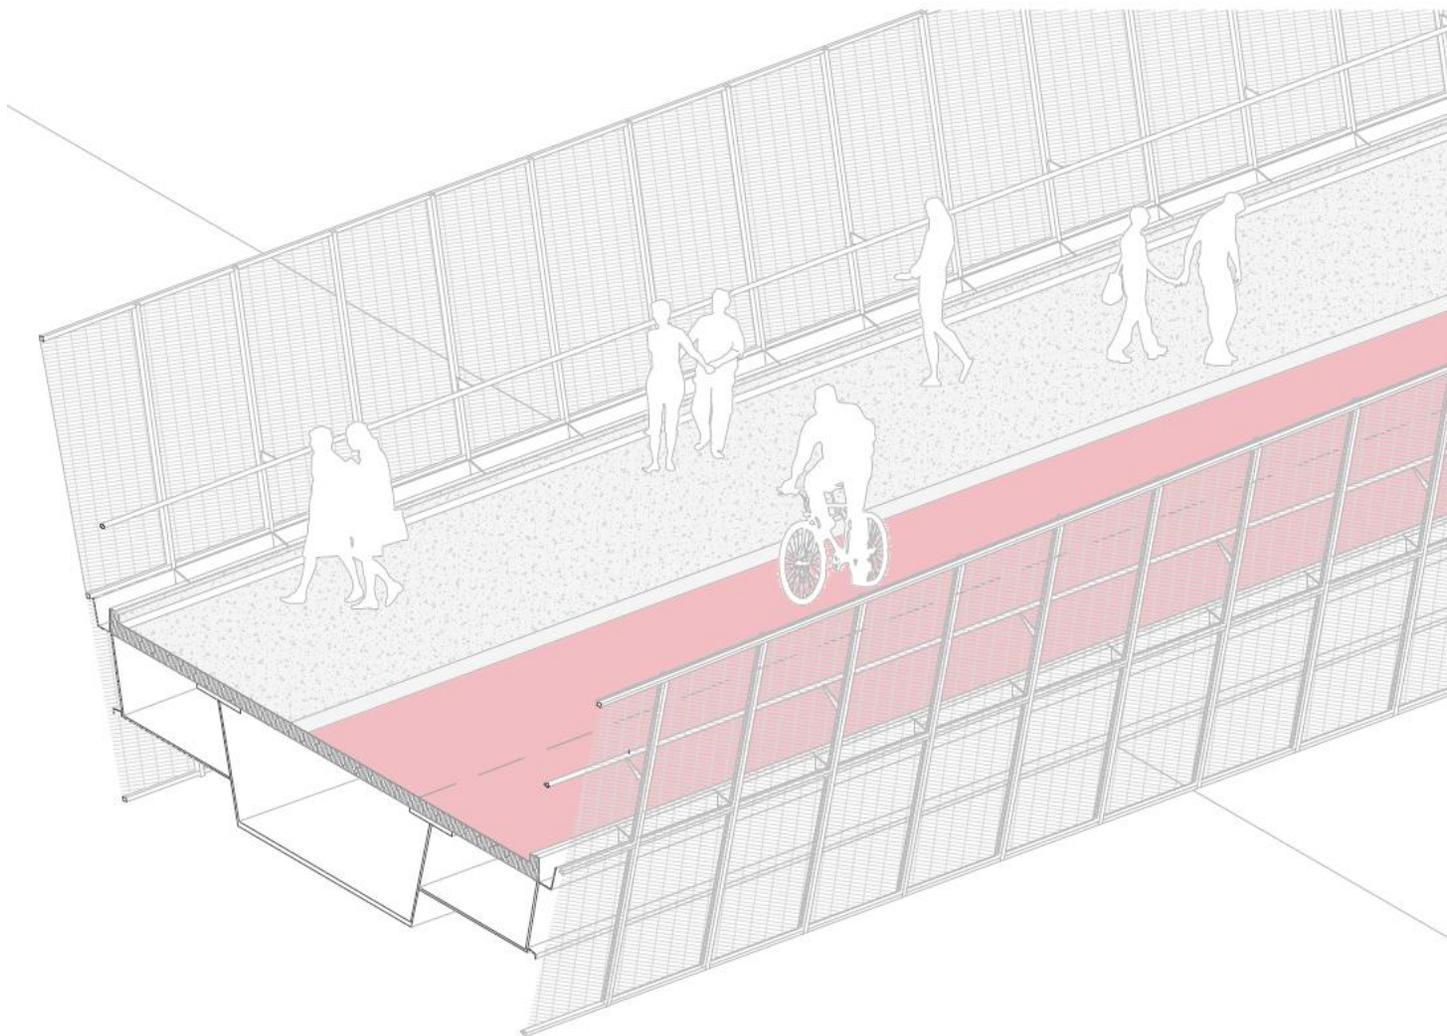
Planta detalle Propuesta Preliminar Pasarela Lo Curro
